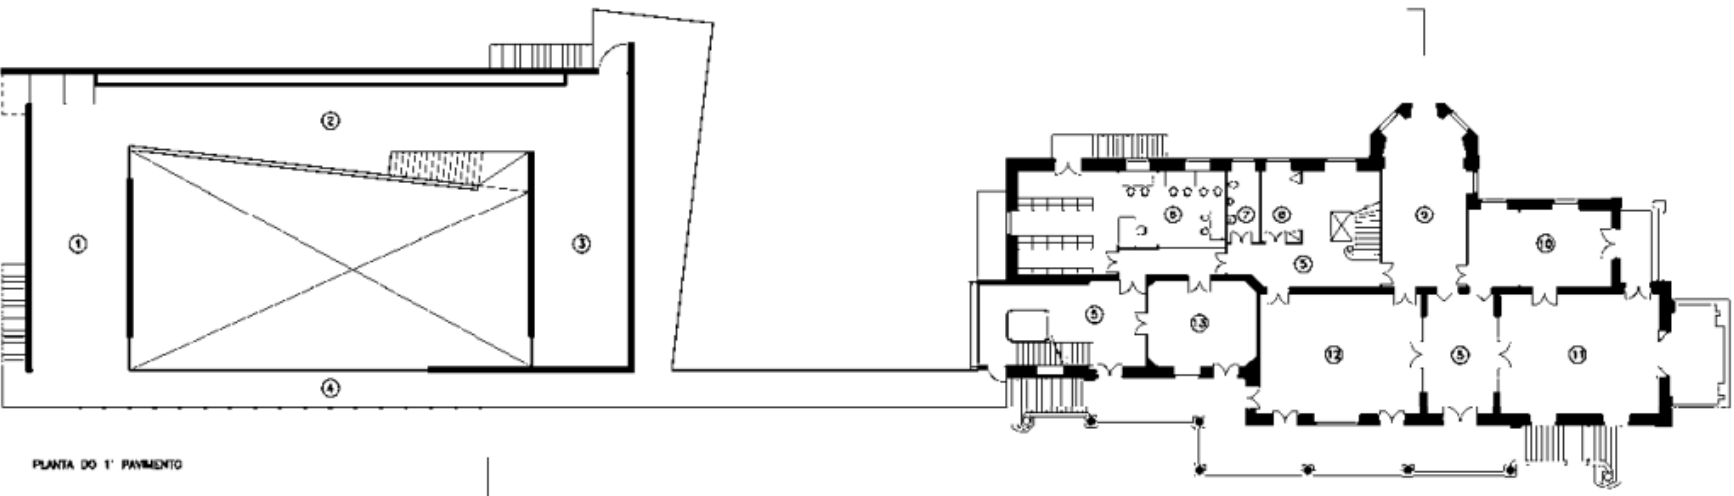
Planta do Pavimento Superior Museu Rodin - Salvador
